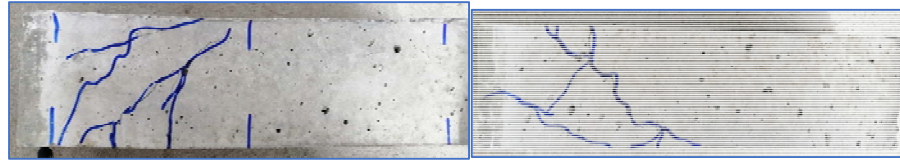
Fallas presentadas en muestra de refuerzo mixto
